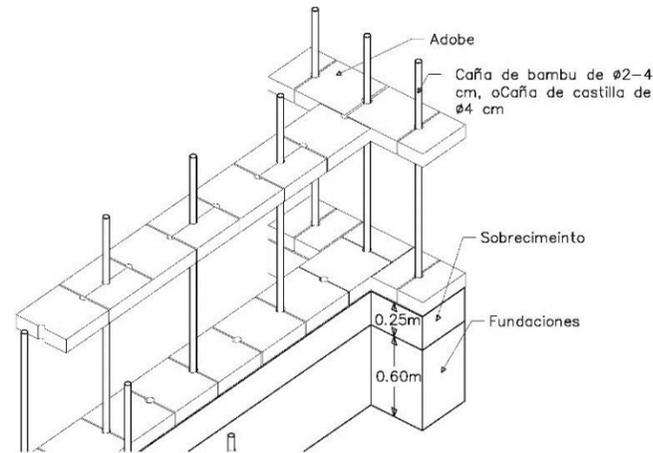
Detalle de unión en tope. Fuente: equipo de trabajo
